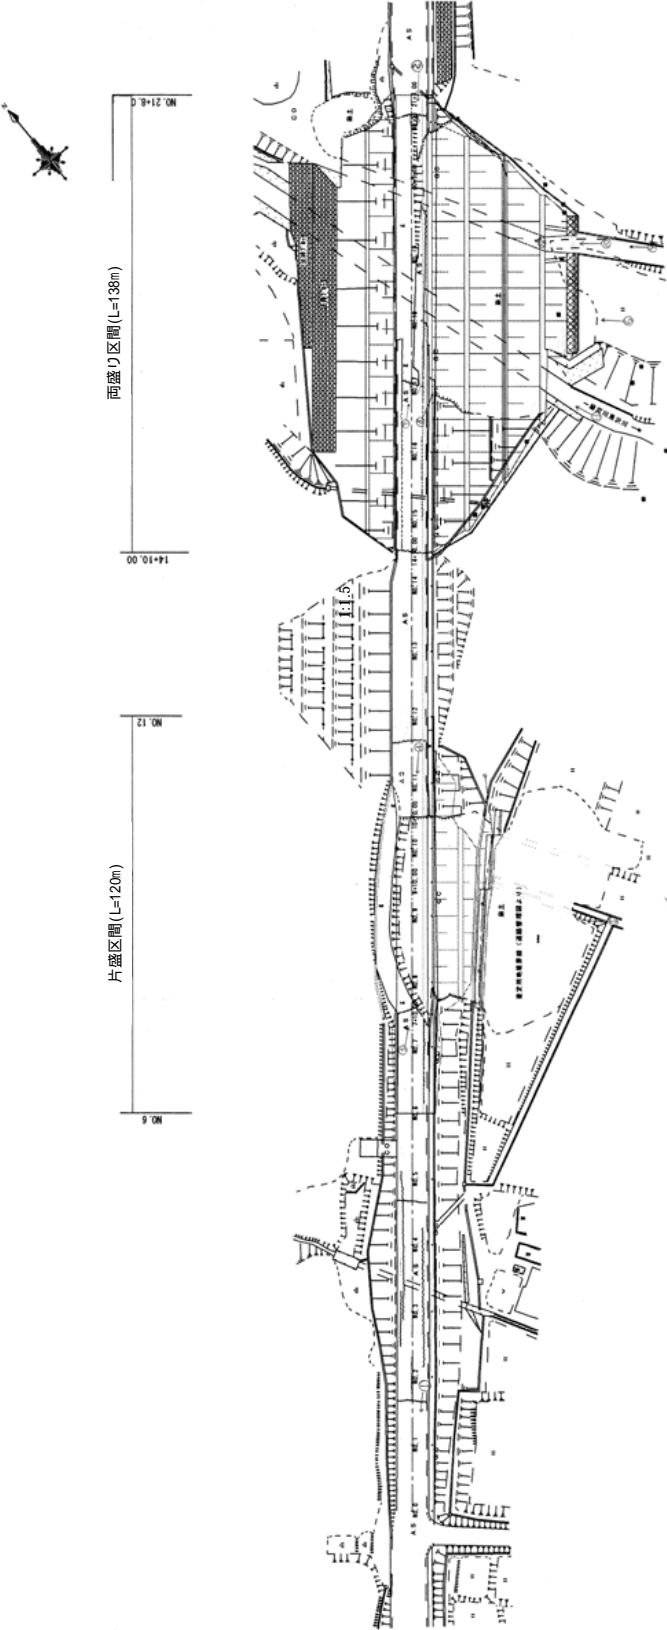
小千谷市細島の崩壊盛土周辺の平面図 (国道 117号)
